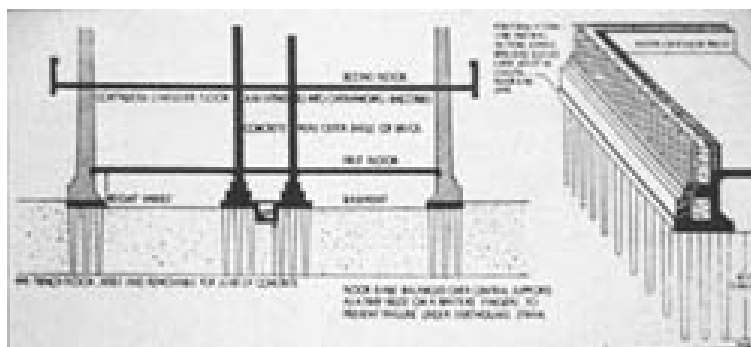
Le fondazioni dell'Imperial Hotel di Tokio 1915 ¹⁵¹
